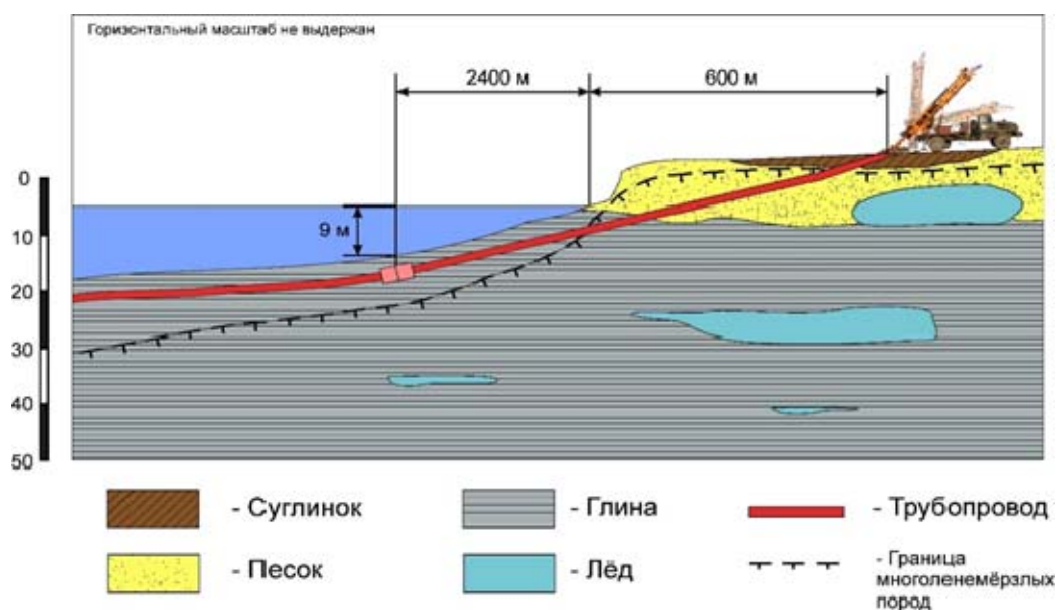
Схема прокладки подводной части трубопровода с учетом грунтовых условий на шельфе Карского моря
